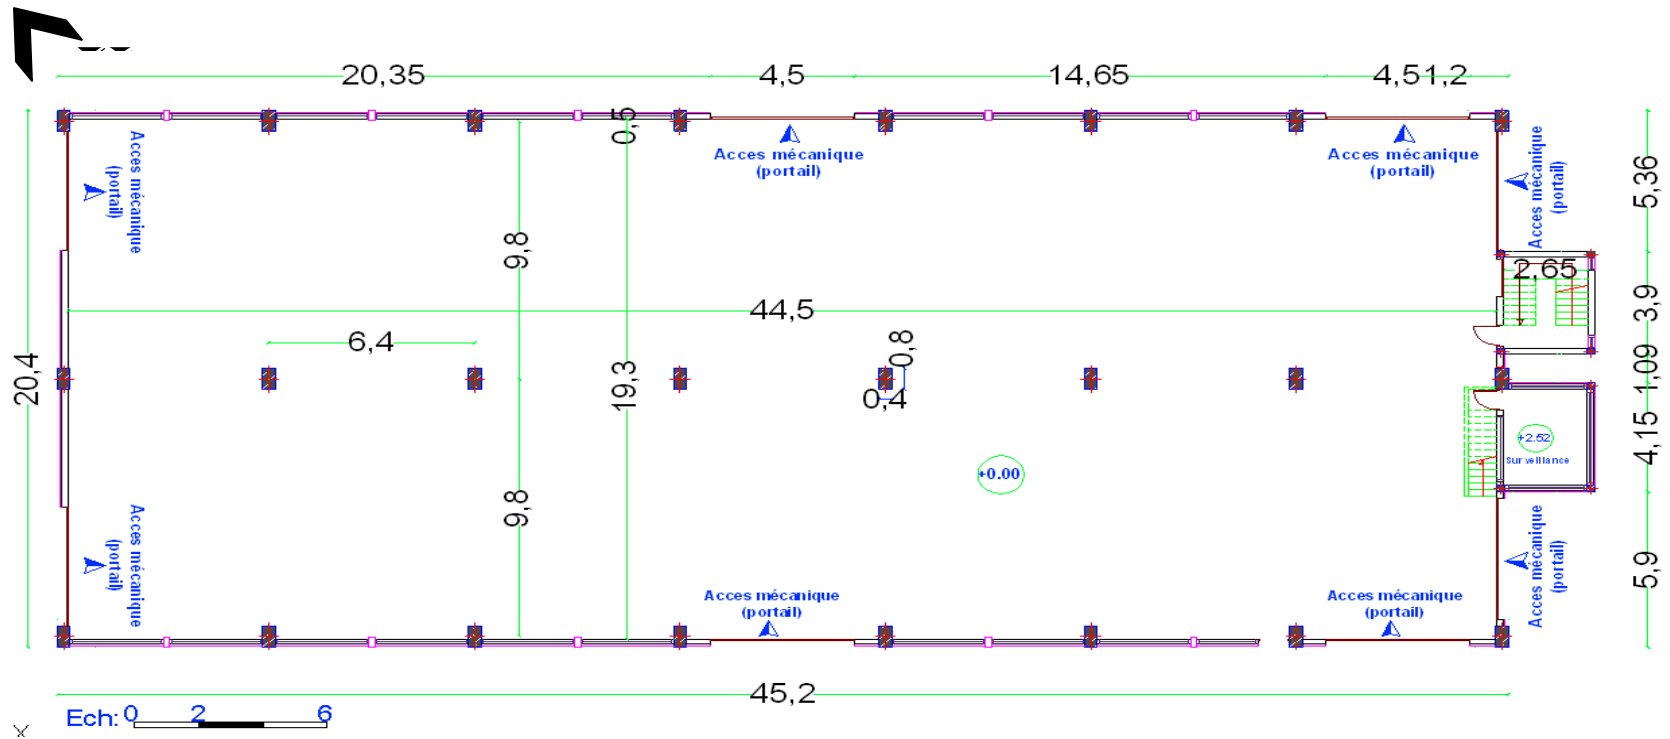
Plan du RDC de l'atelier vilebrequin. (Source : l'auteur).
